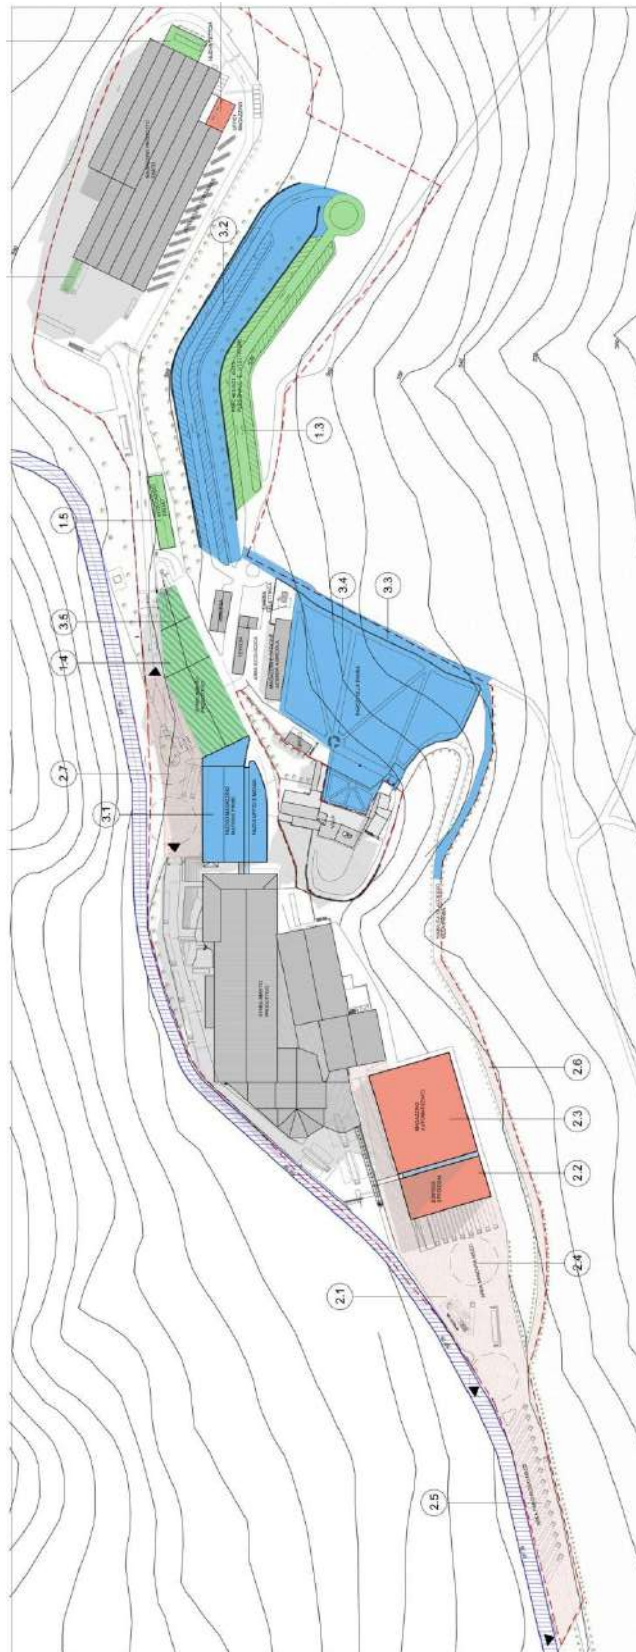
Masterplan: Planimetria assetto finale (versione del 2019 ante CdC del dicembre 2020)
